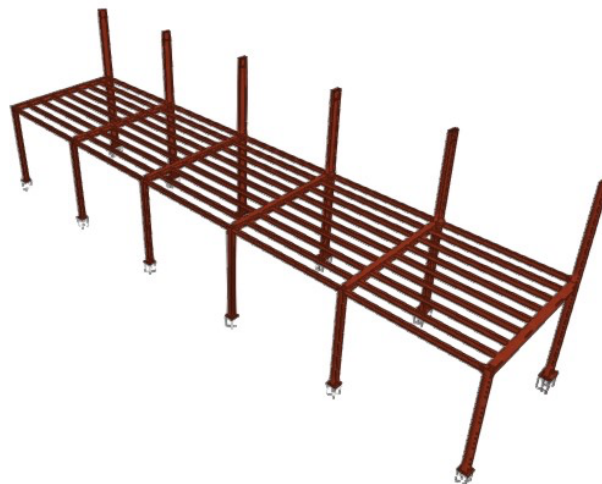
Estructura metálica altillo. CYPE Ingenieros.
